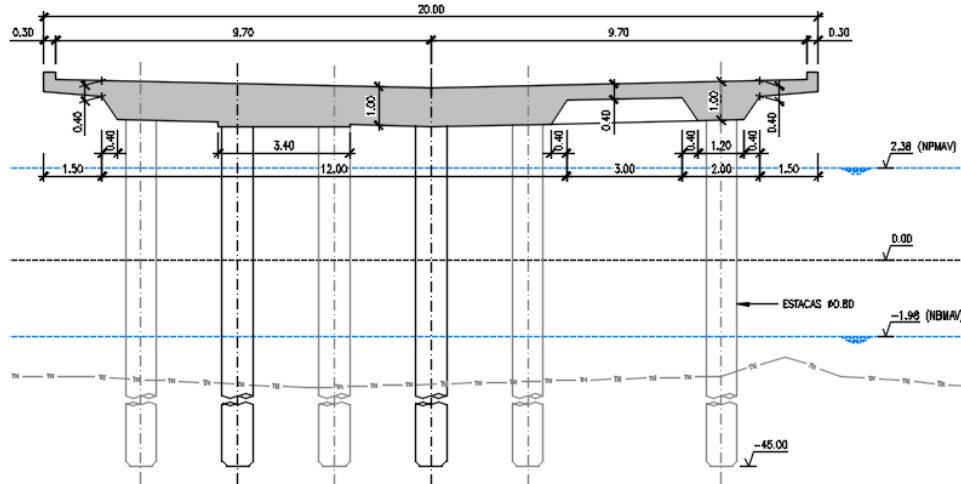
Secção tipo do cais (Fonte: Projeto de Execução).
